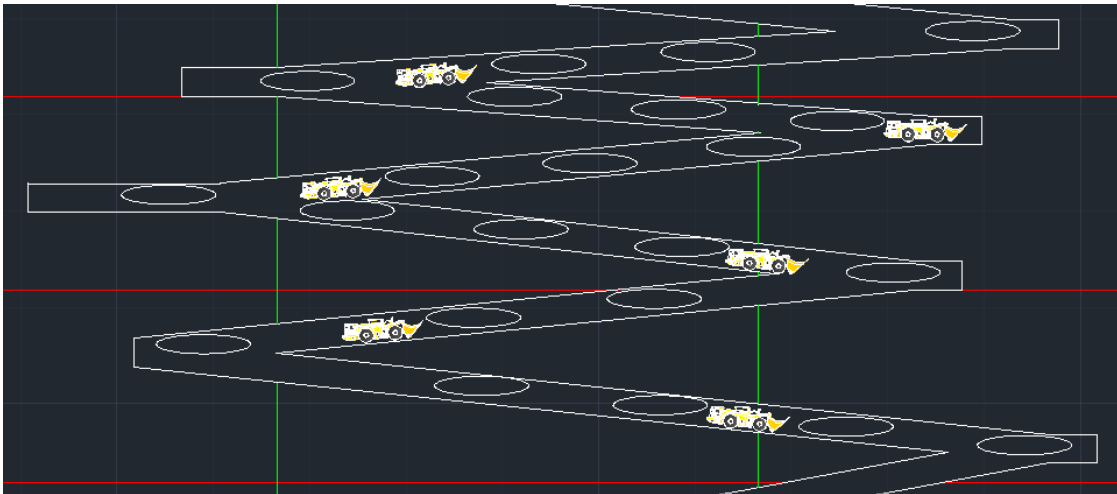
Zonas identificadas con bordes por rebajar en Rpa-2200
